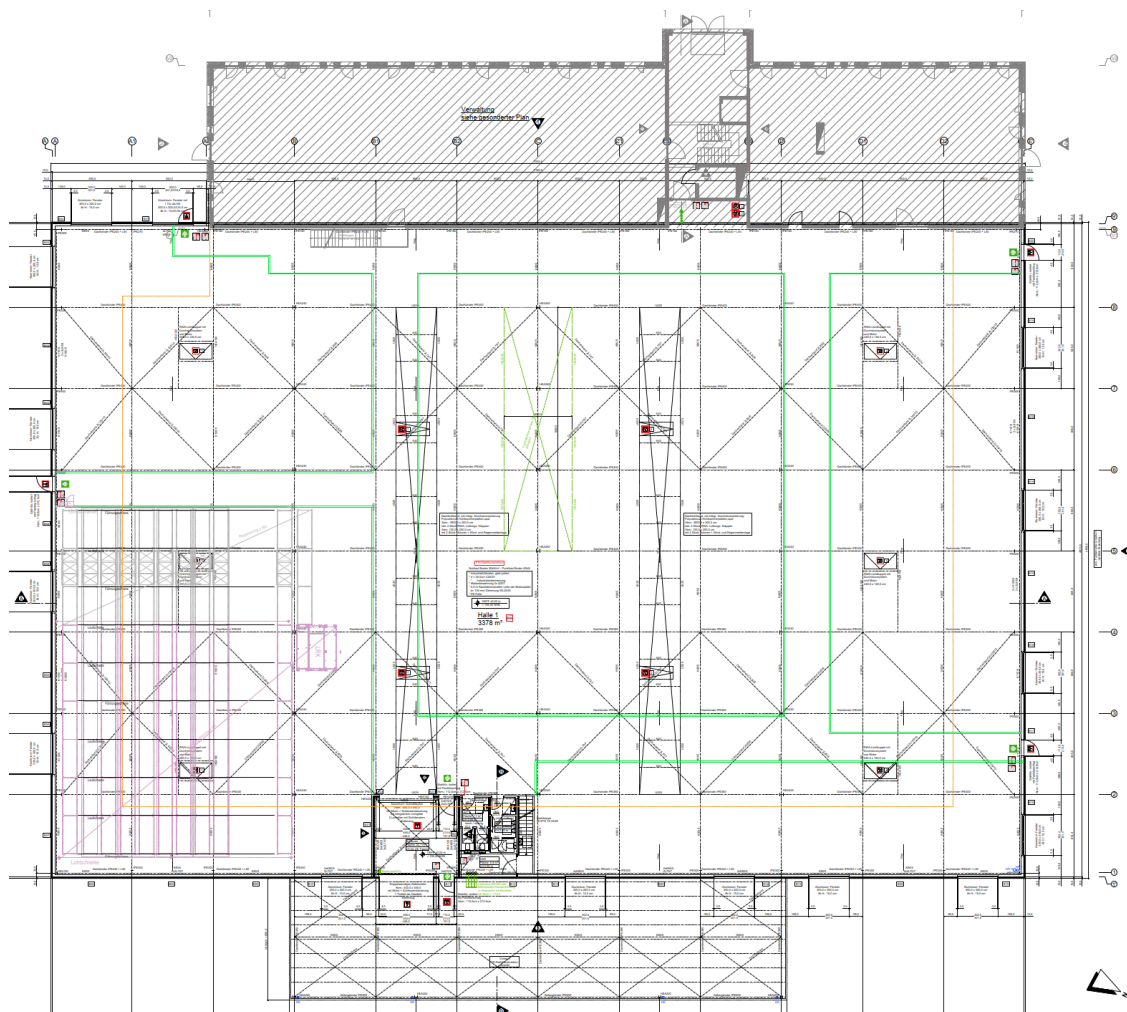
Grundriss Erdgeschoss – Halle und Verwaltung
